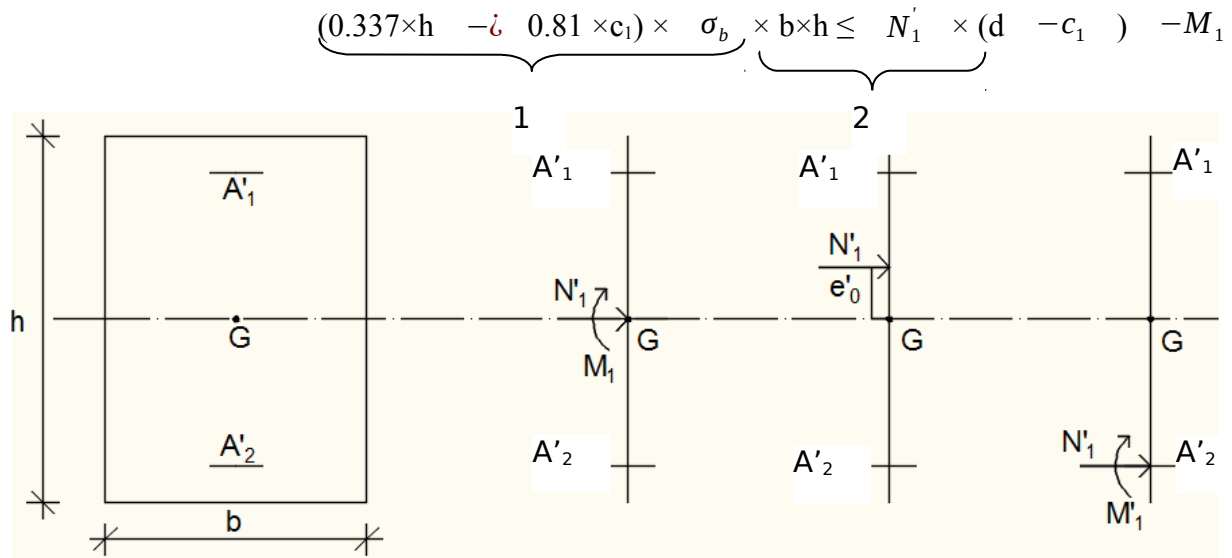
Position de N'_1 , M'_1 et M_1 sur la section transversale.
